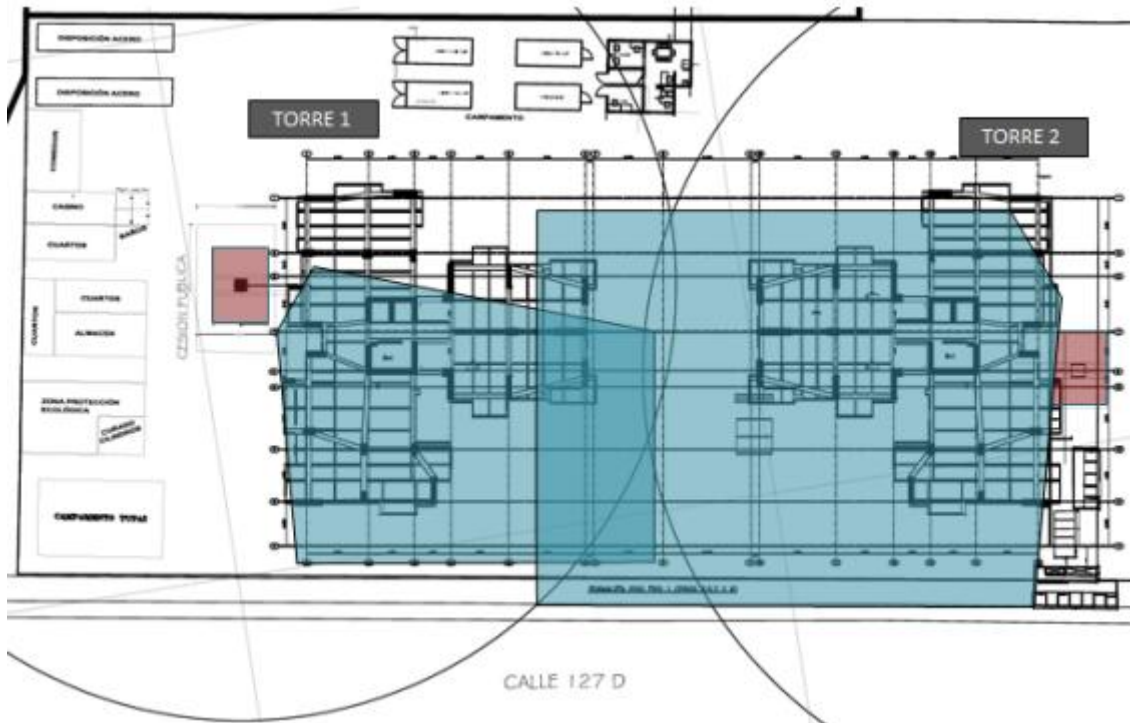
Áreas cubiertas por las cámaras 1 y 2
